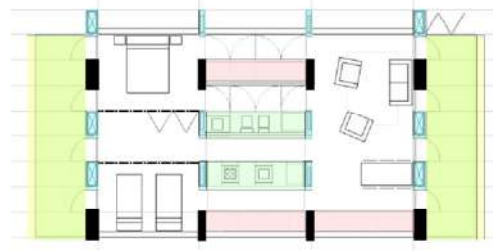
Planta Apartamento Tipo 2 - 78 m²
